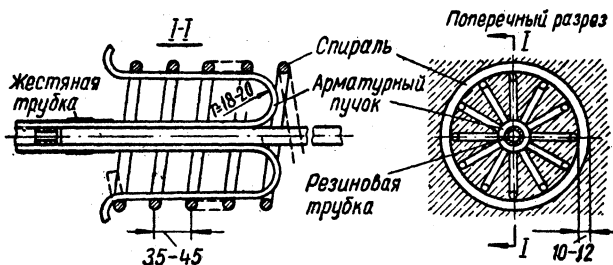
Анкеровка арматурных пучков крюками и спиралью.
